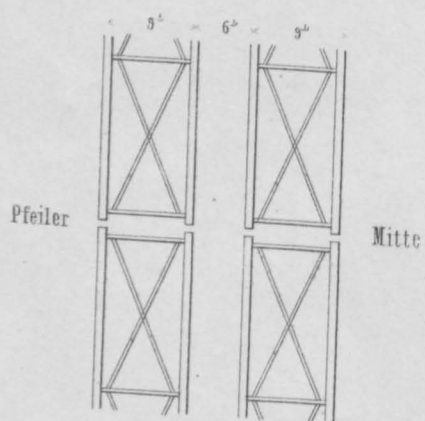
Grundriss der Pfeilerendigung nach F.F.
